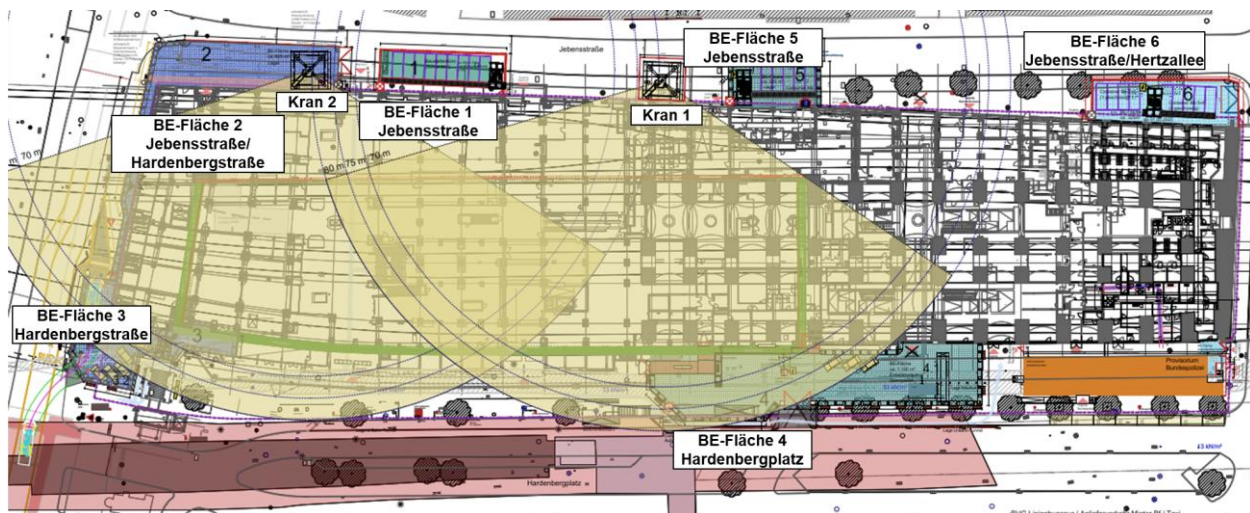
Übersicht der Baustelleneinrichtungsflächen
